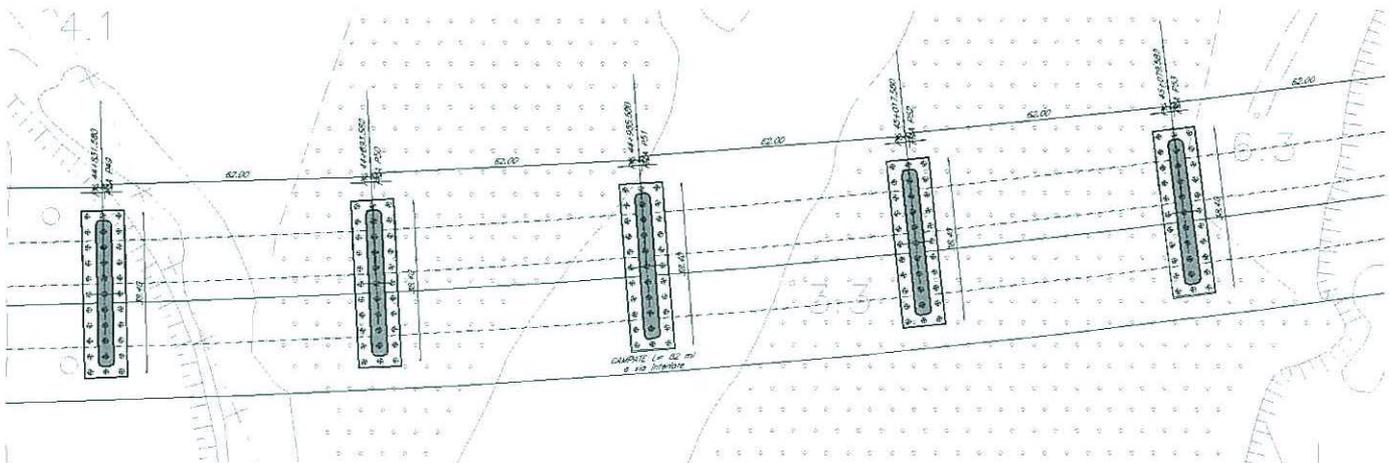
Pianta fondazioni in corrispondenza dell'attraversamento dell'Isonzo.
